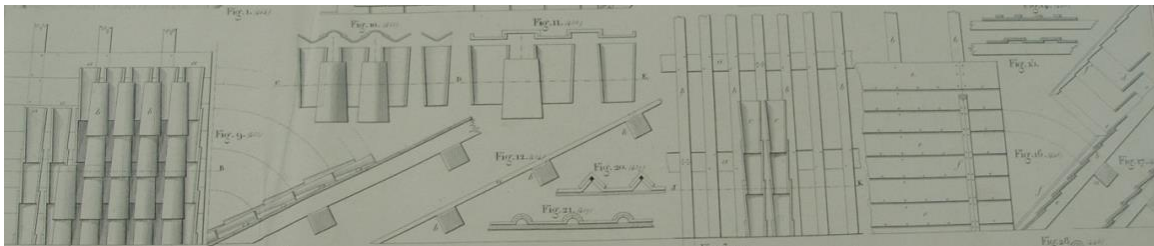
Instalación de tejas en cubierta de madera. Fuente: (Émy, 1841-1842).
